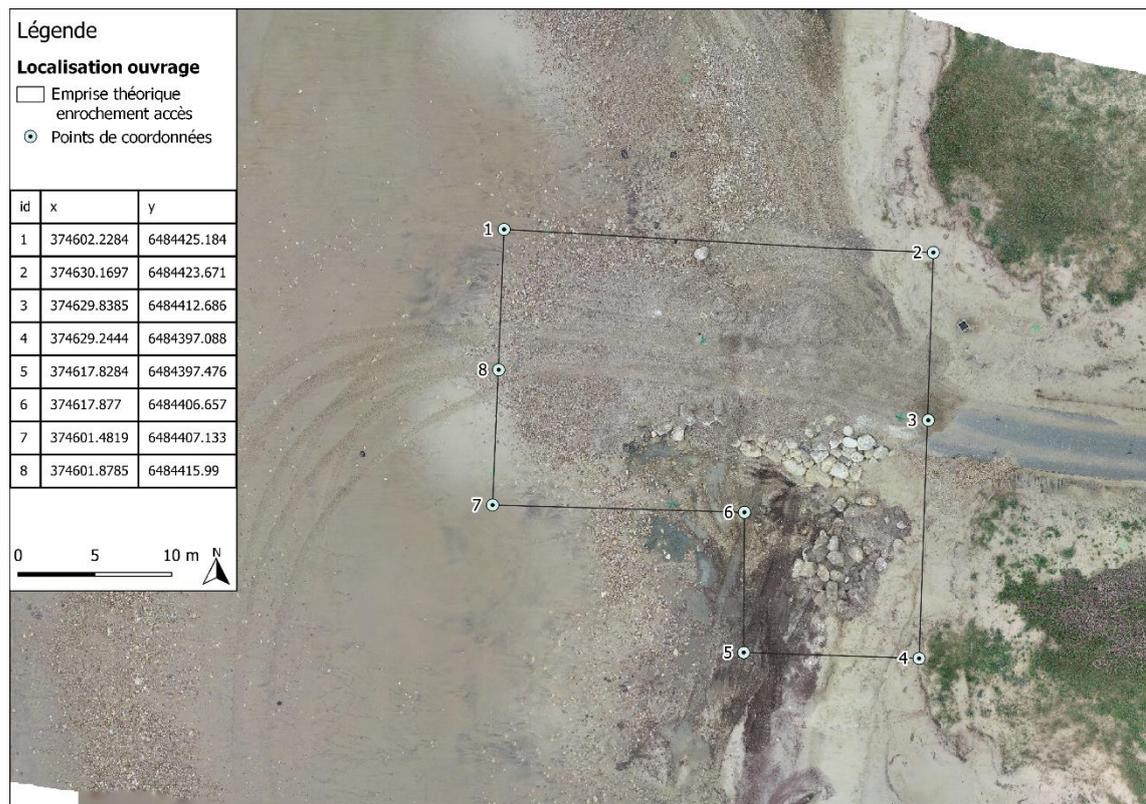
Plan de la descente d'accès et coordonnées de l'ouvrage en Lambert 93 (CASAGEC, 2021).
